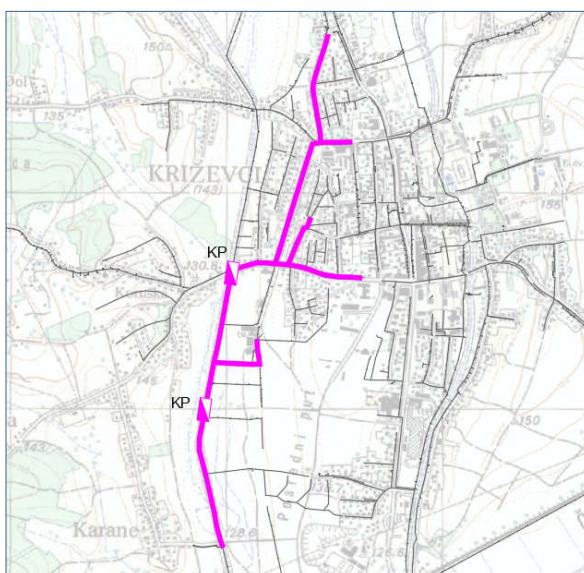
Planirani zahvat - mjere rekonstrukcije i sanacije postojećeg sustava odvodnje
